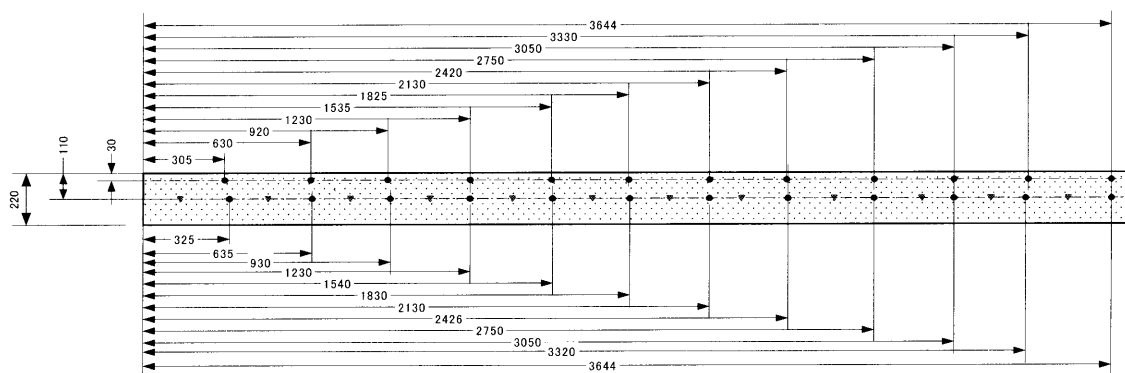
供試体① 側面 B 側 鉄筋位置
